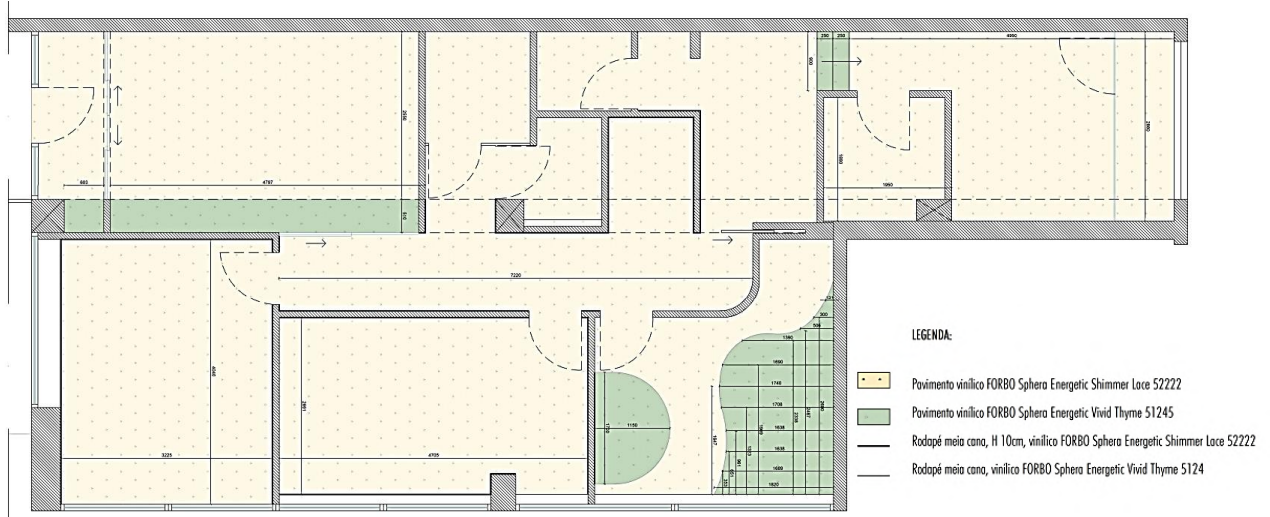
Planta técnica de pavimento - Projeto CNP. Fonte: Equipa FBN.
